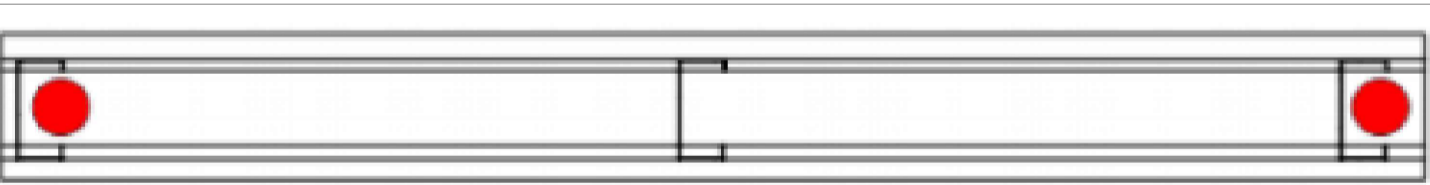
disposição dos chumbadores, instalados a cada 80 cm
